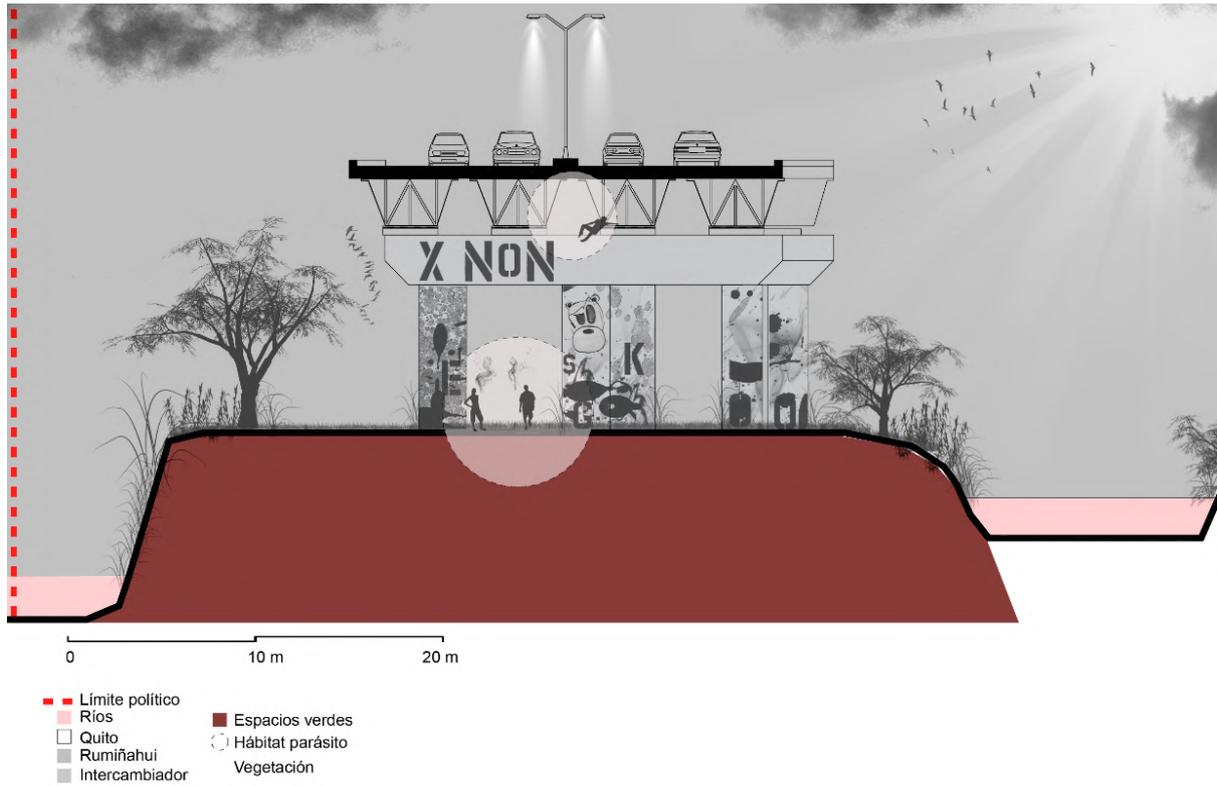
Sección longitudinal 1, zoom 2. Elaboración autor.
